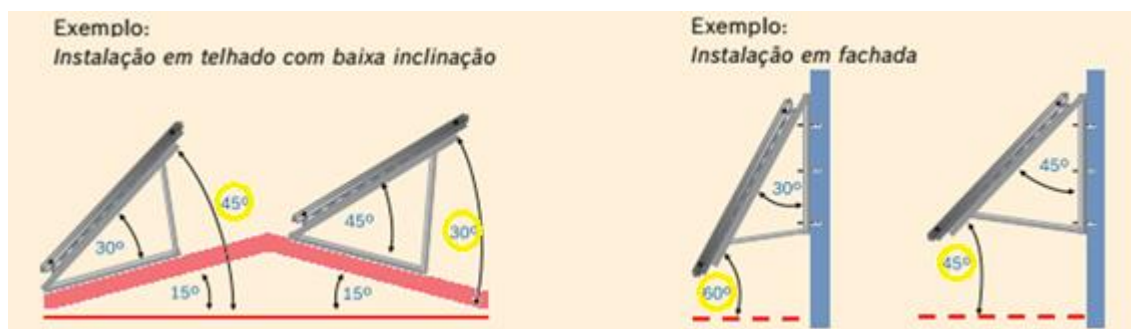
Exemplos de instalação em telhado e numa fachada. [10]
